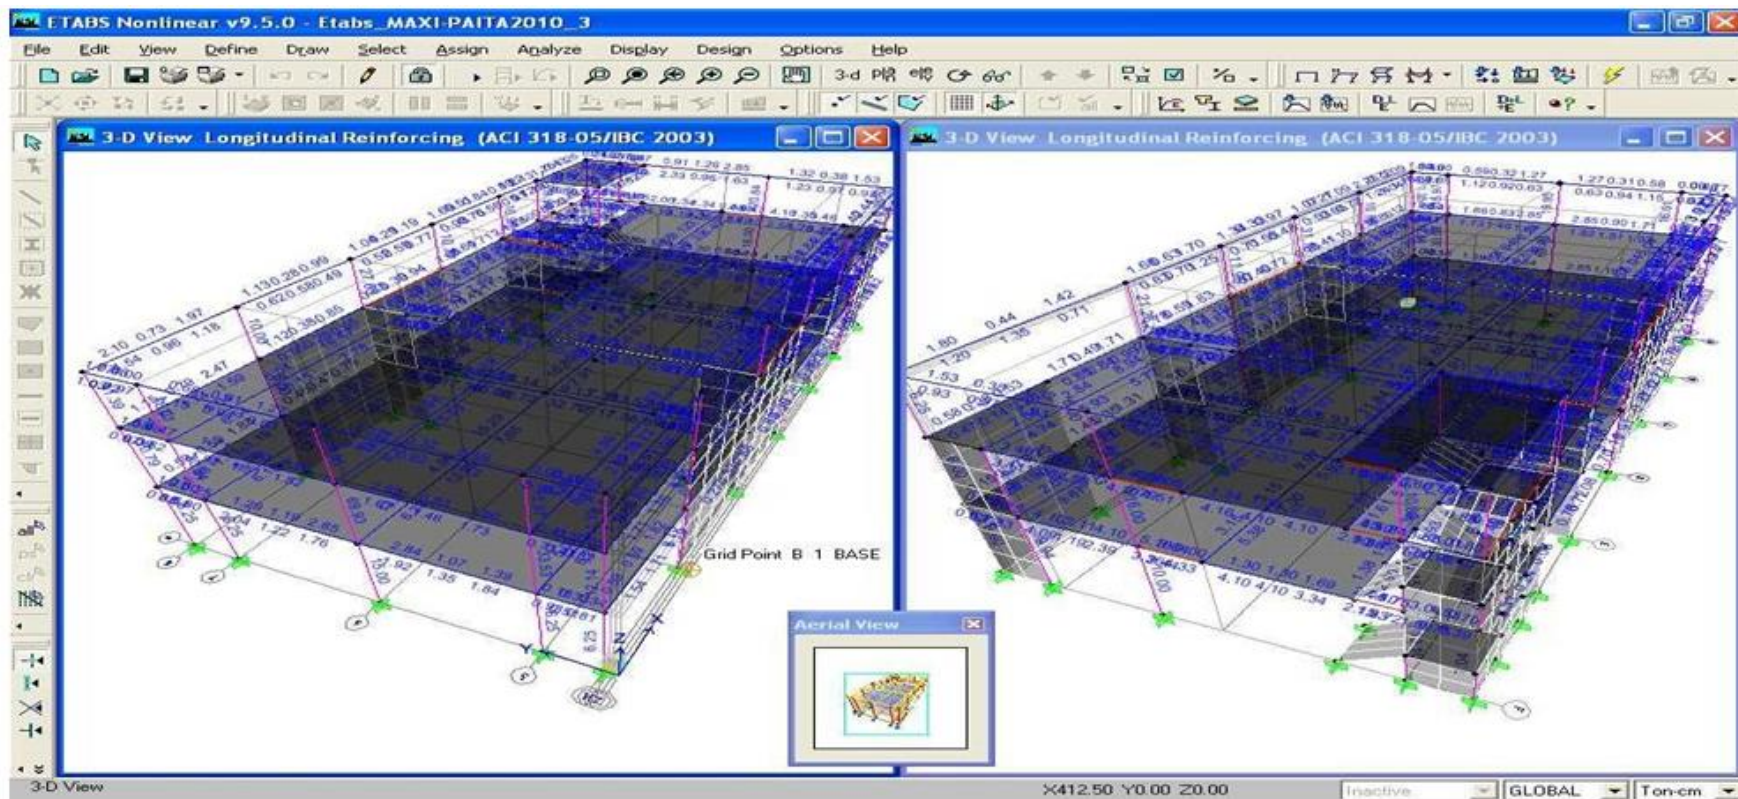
Diseño de refuerzo longitudinal, en vigas y columnas.
